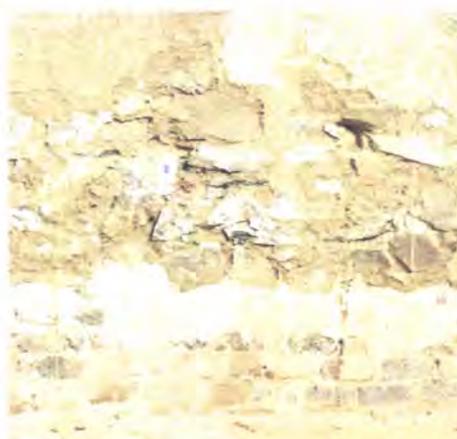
Fundações de pedra granítica e tijolo com uma fina camada de barro de ligação com a taipa, rua do Carmo nº 17
